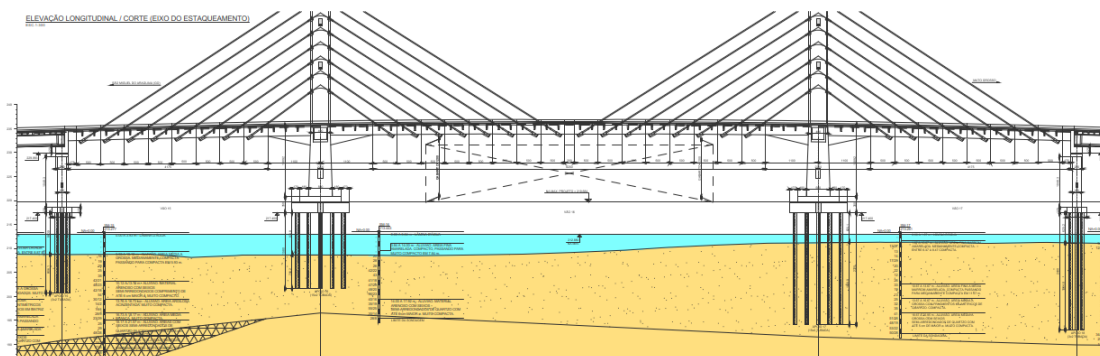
Elevação do projeto de fundações – Apoios 16 e 17
